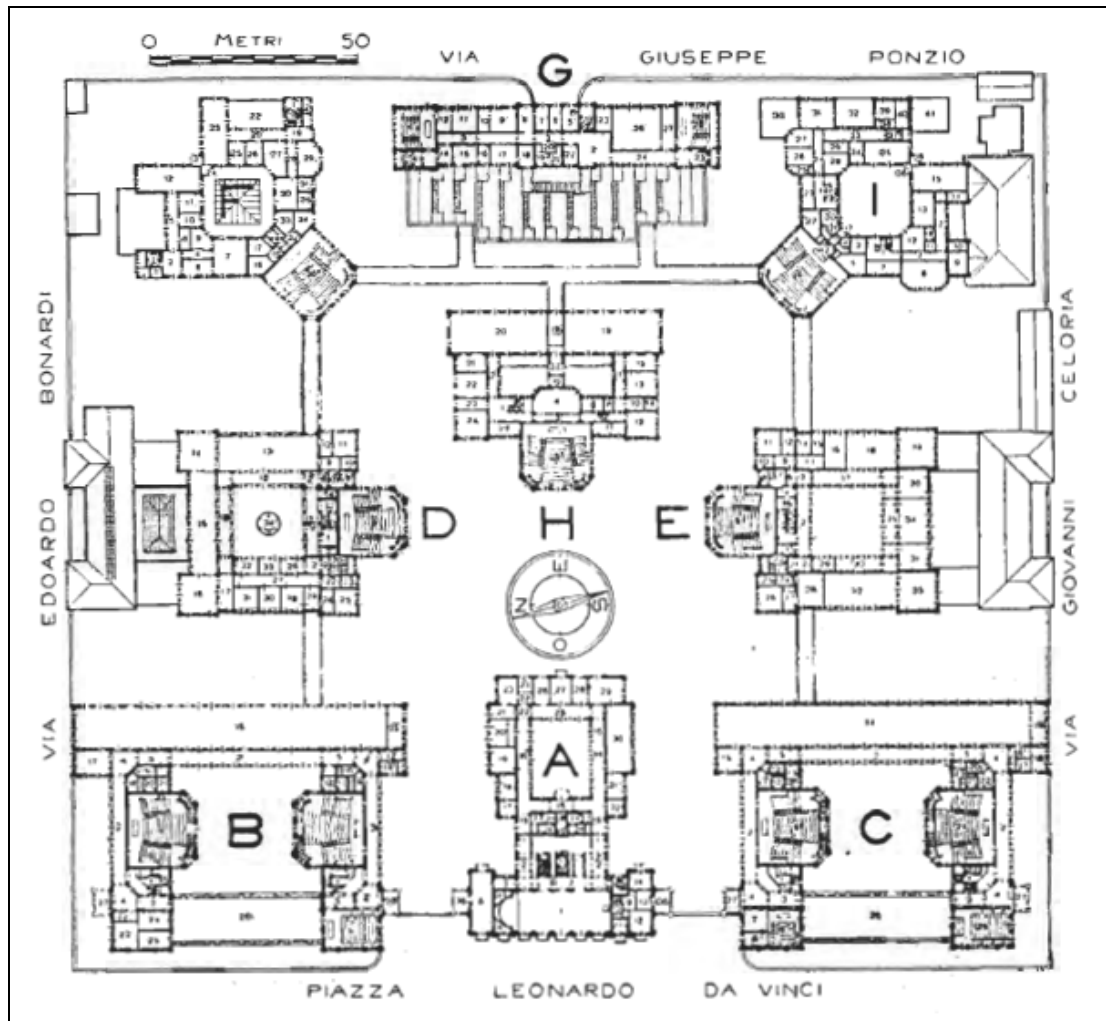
Planimetria generale del piano terreno del Politecnico
